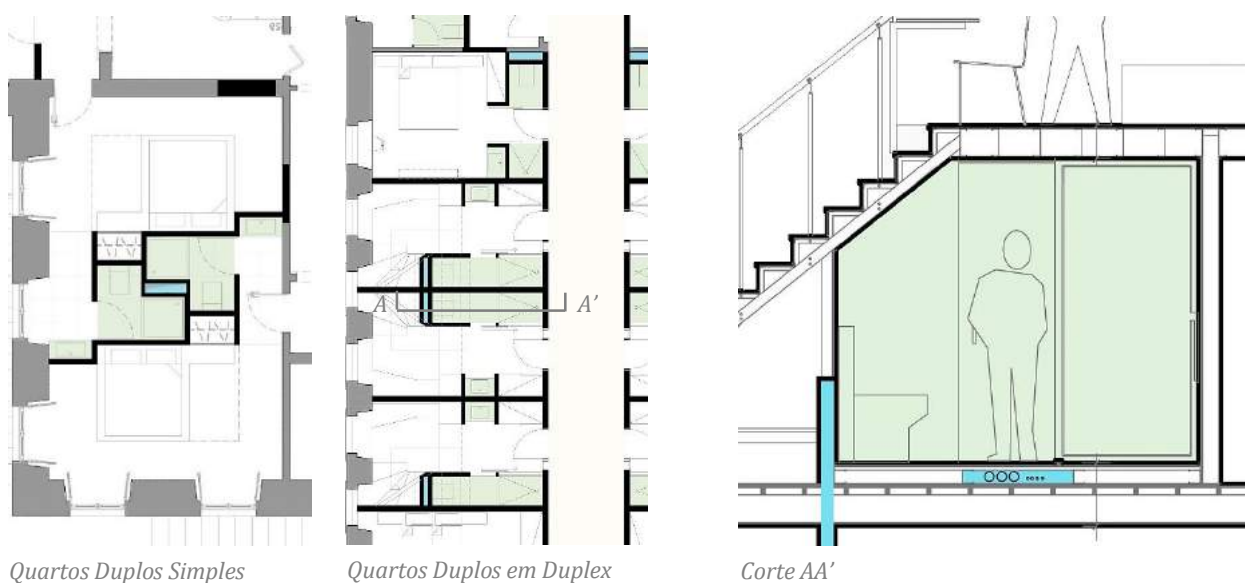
Plantas e corte esquemático de duas tipologias de quartos propostas no piso 1 do Asilo, onde é possível observar as courettes e calhas técnicas
